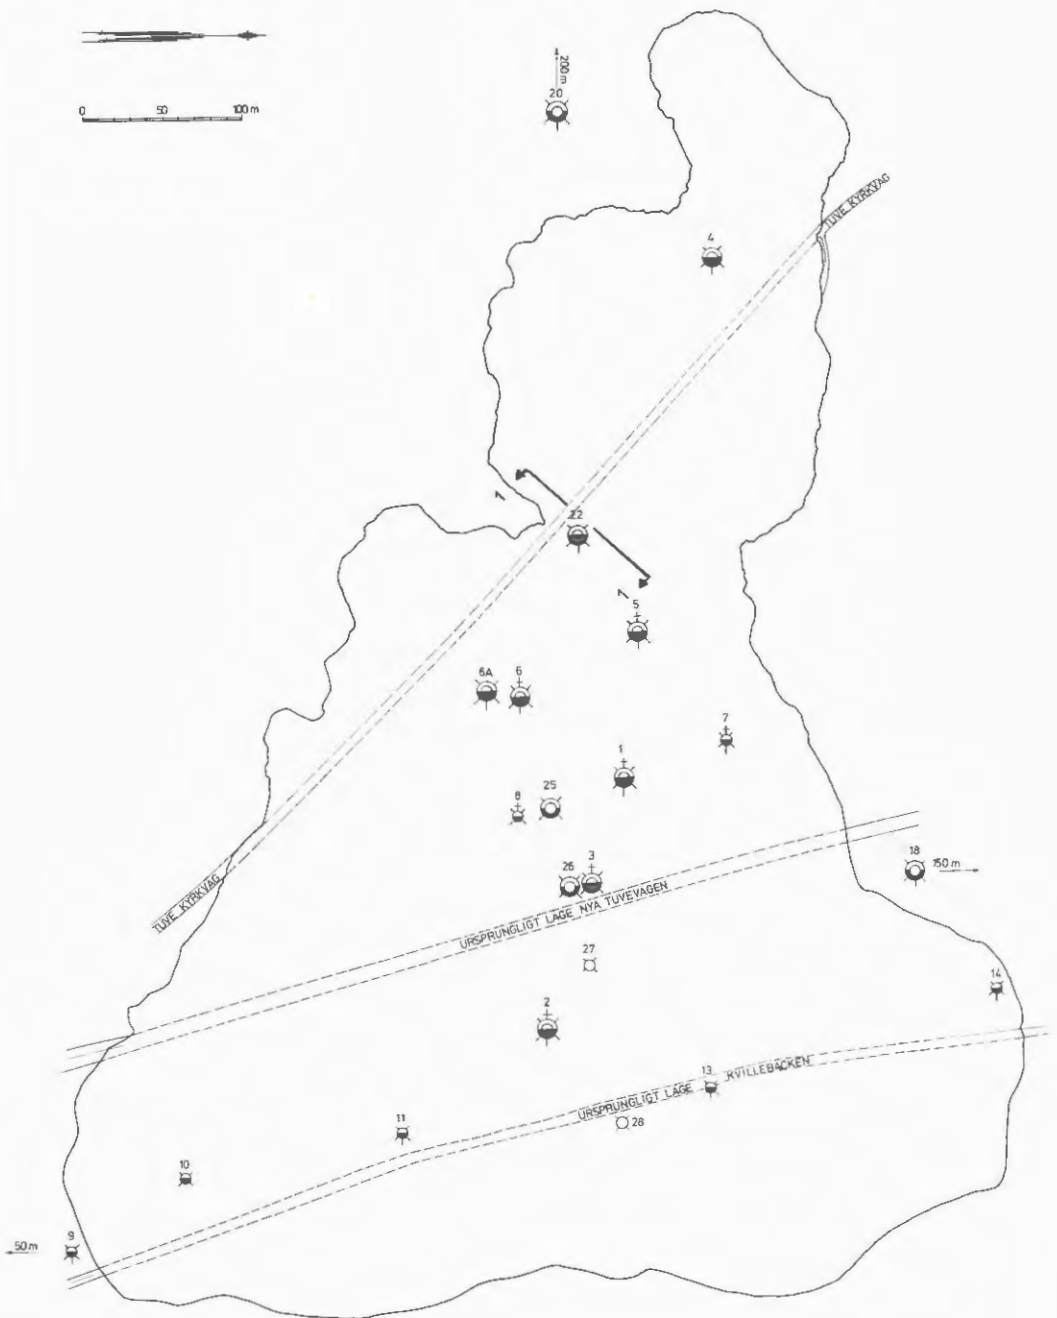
Plan över SGI:s undersökningspunkter-
